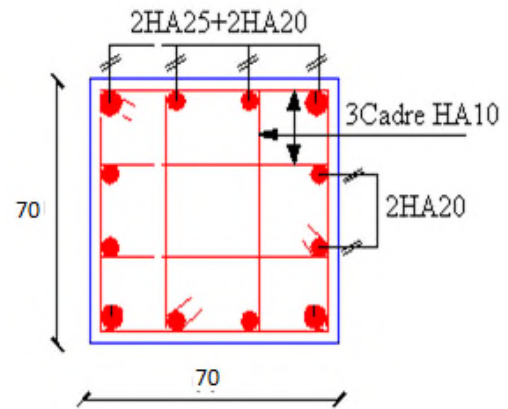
Schéma de ferrailage des poteaux (4^{ème} et 5^{ème} entre sol)
